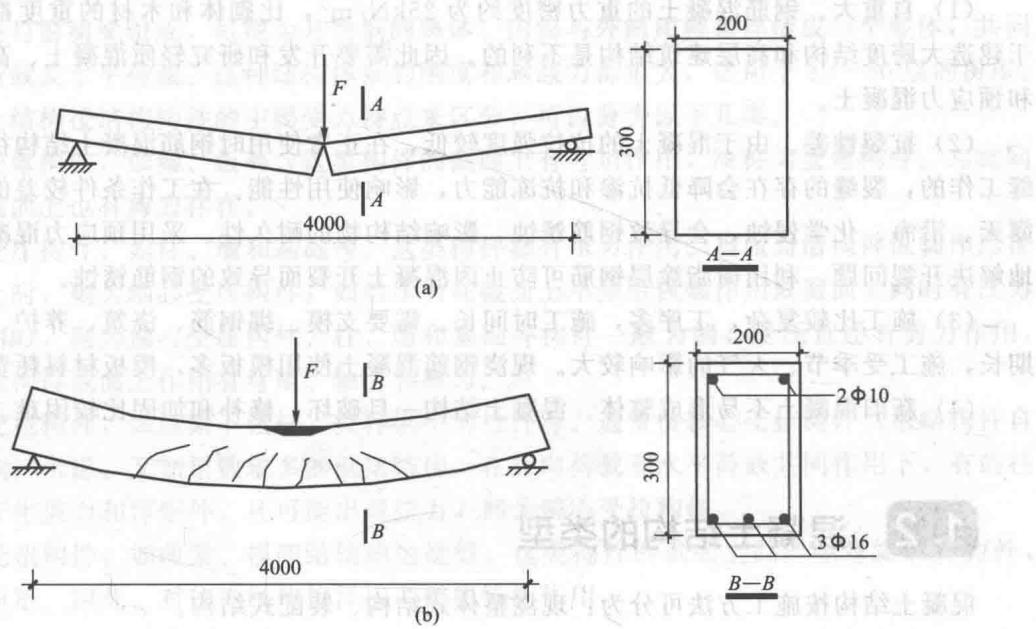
素混凝土与钢筋混凝土梁的破坏情况对比
